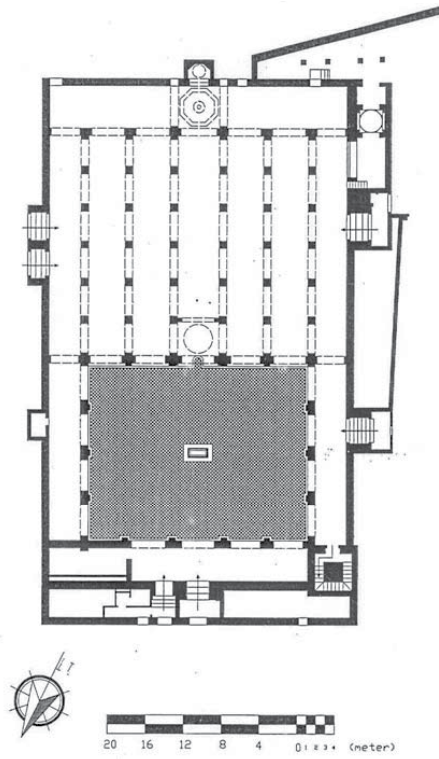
جامع حسان بالرباط، مسقط أفقي، عن:
